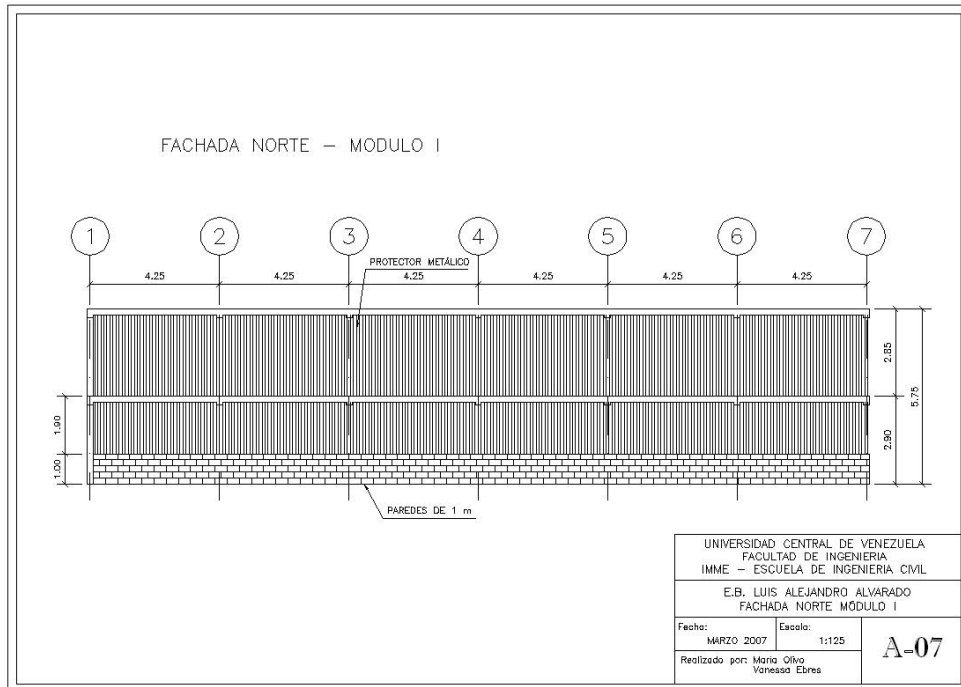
Plano de la Fachada Norte del Módulo I.
